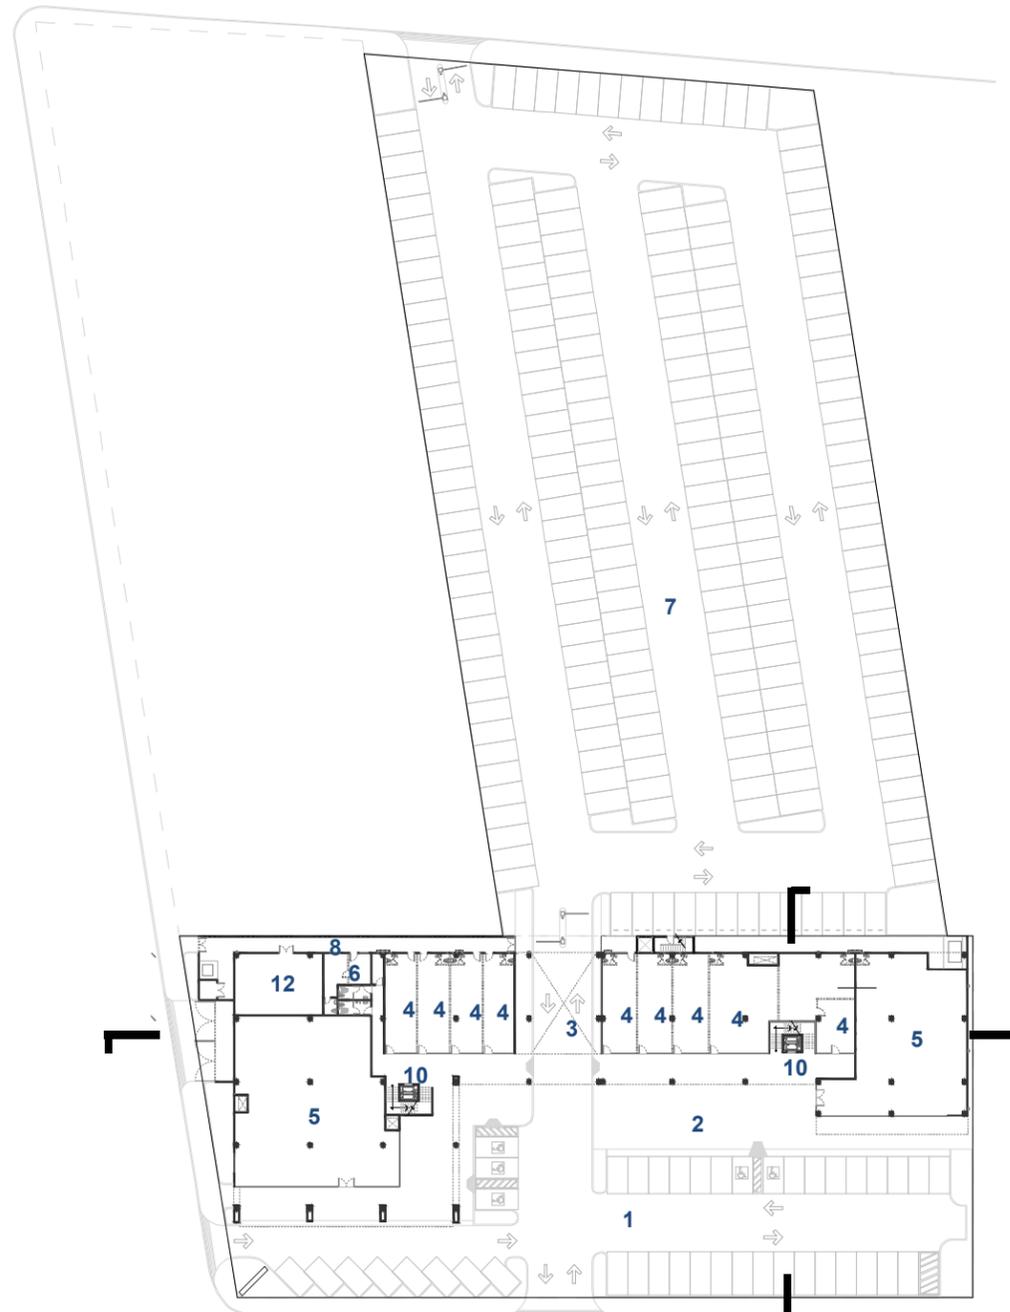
Planta baja y de conjunto 109°28' Work Spaces Río.
